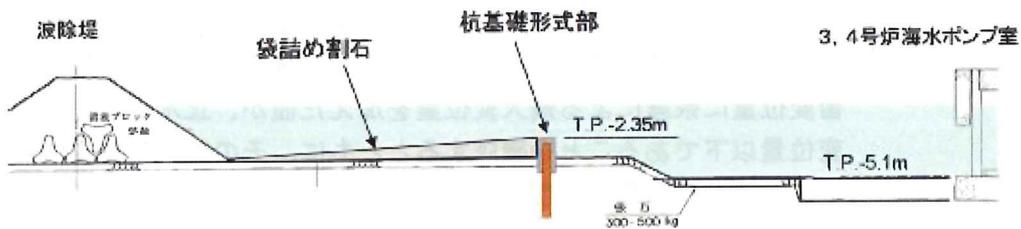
貯水堰断面図 (①-①断面) (杭基礎形式部)
